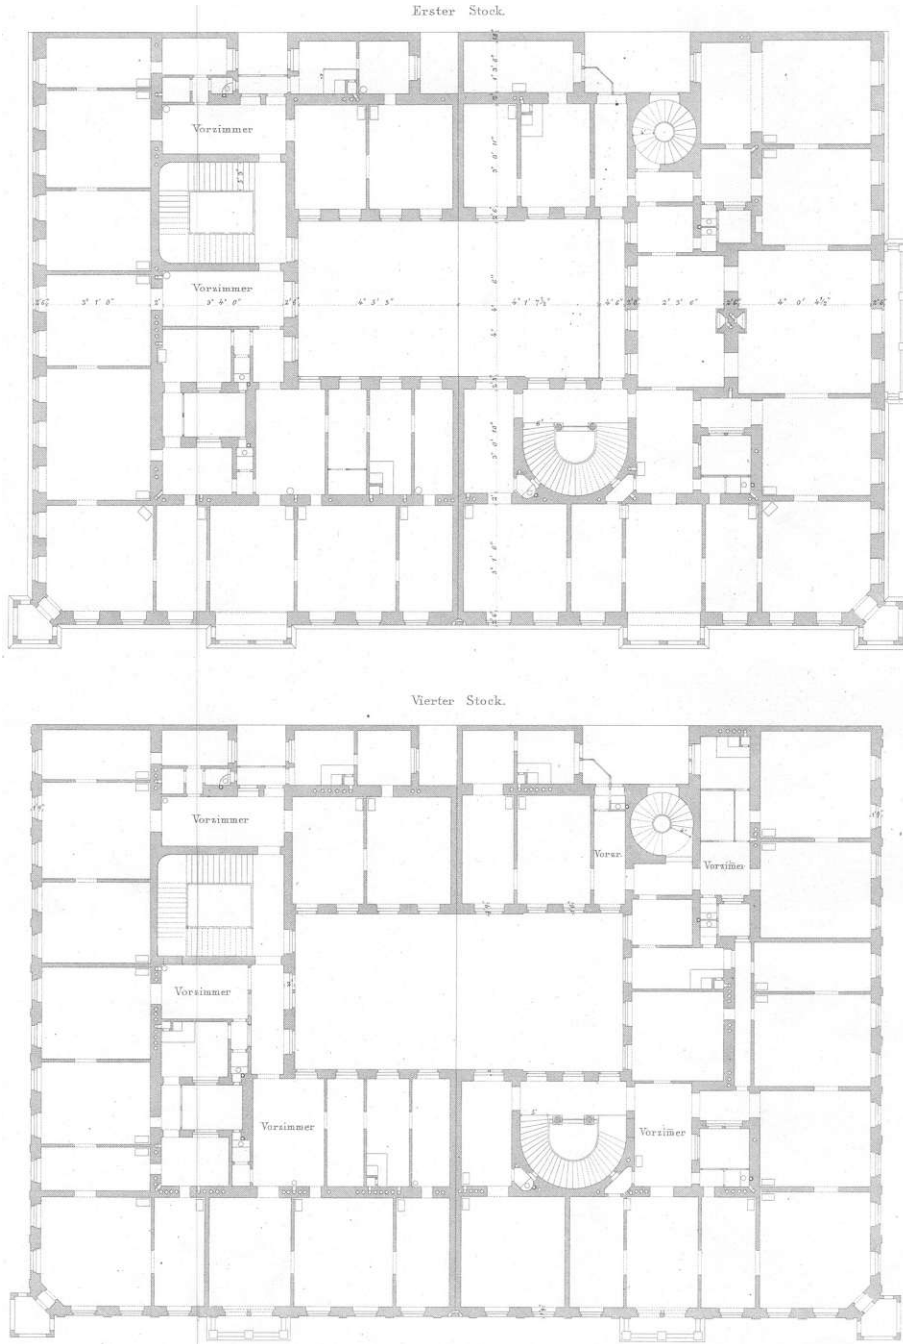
Grundrisse 1. und 4. Obergeschoss, Zinshäuser an der Kärntner Straße Ecke Ringstraße - Ludwig Christian Förster, 1862
